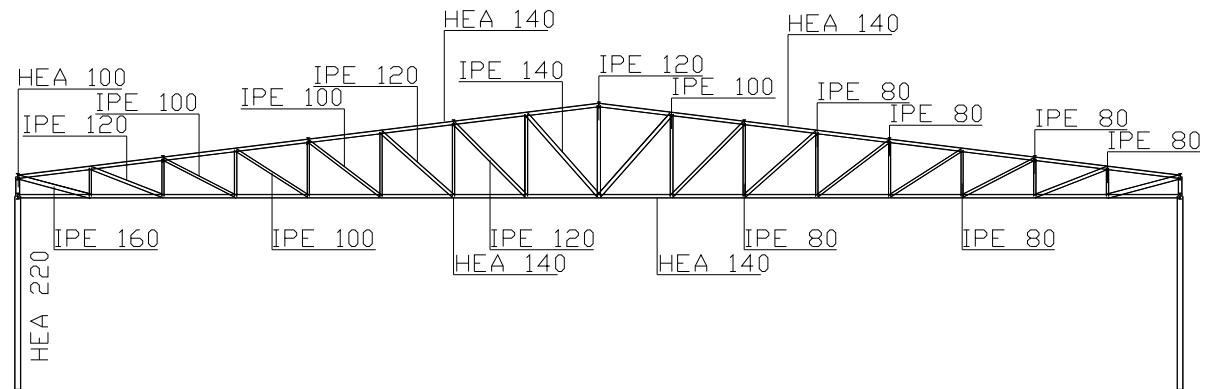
Pórtico com pilar de alma cheia, viga em treliça, vão de 40.00m, pilar em perfil com secção transversal HEA, viga em perfil com secção transversal HEA/IPE.
